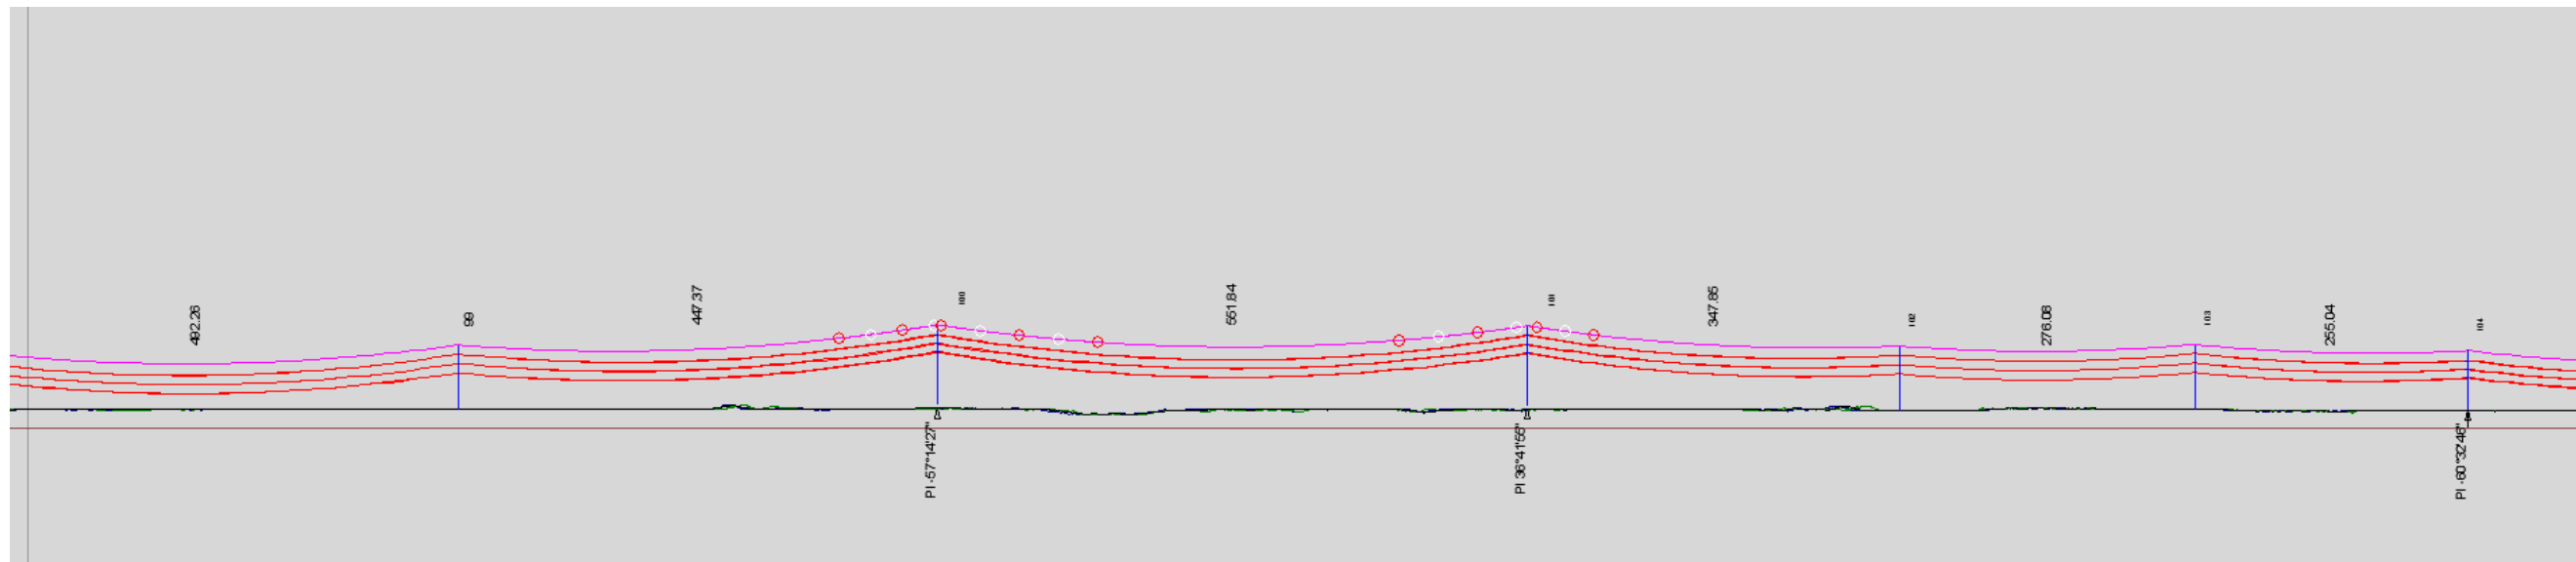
Sezione/profilo schematico del progetto "variante in affiancamento all'autostrada" (cfr. doc. RECR10001CSA00283) (H tot sostegni attraversamento 58-76m)
